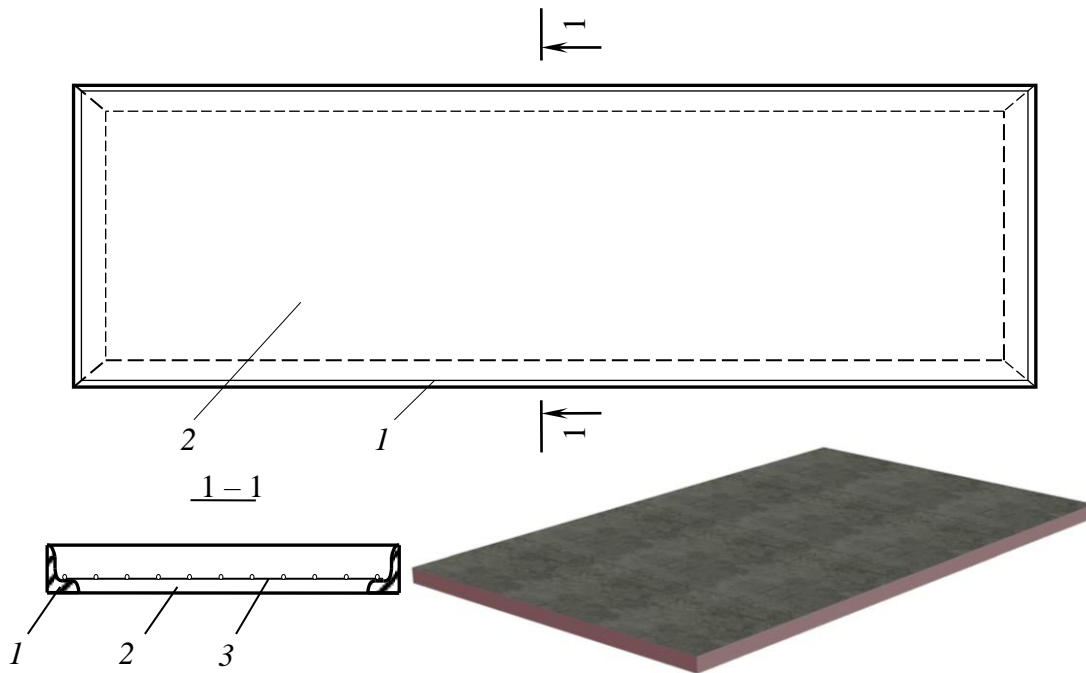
Збірна залізобетонна плита перекриття зі сталевим обрамленням
